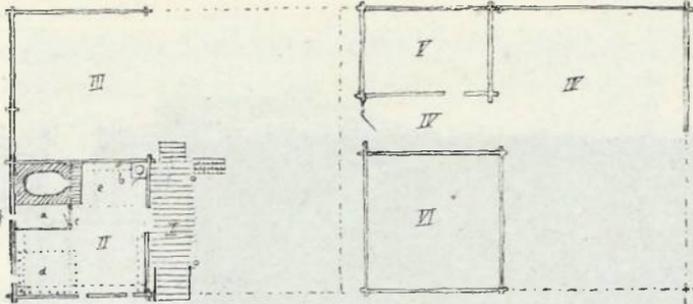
Grundriss des Hauses in Abb. 7.
